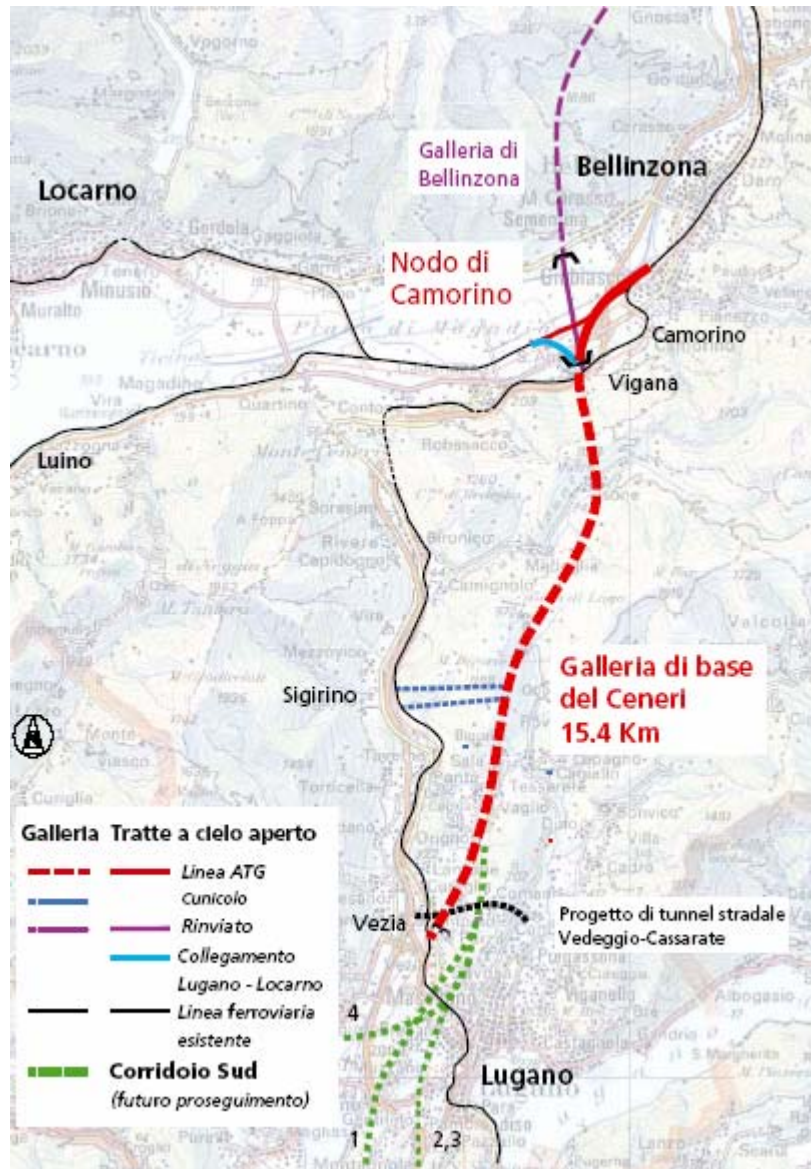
Rete RTE-T – Planimetria della galleria del Ceneri
